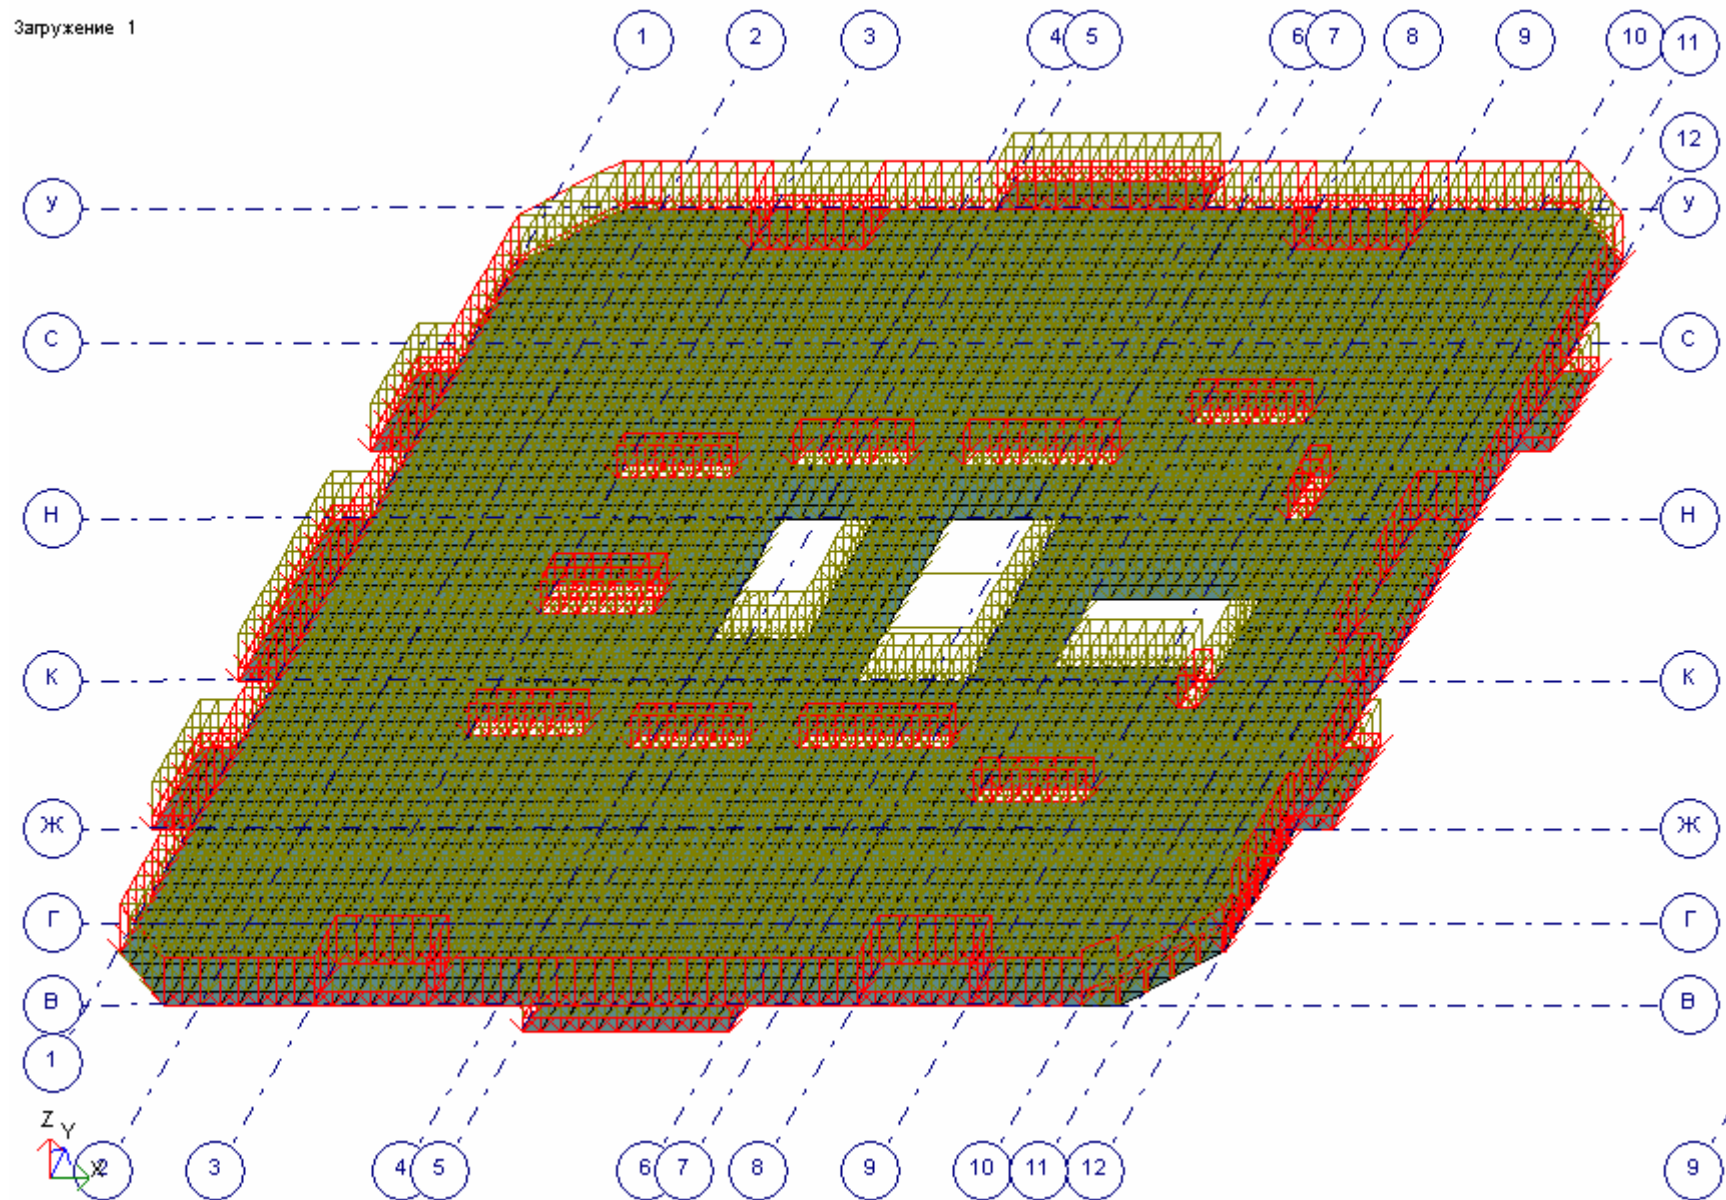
Действие ограждений и кладки вент. каналов на перекрытие типового этажа
